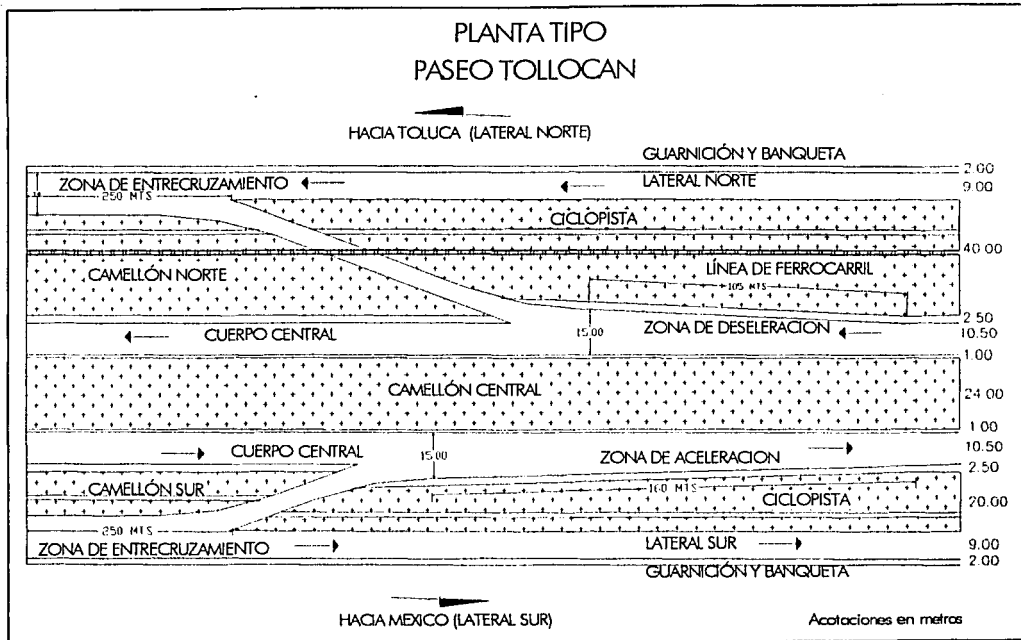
Planta del paseo Toluca, donde se pueden observar los elementos que lo conforman.
